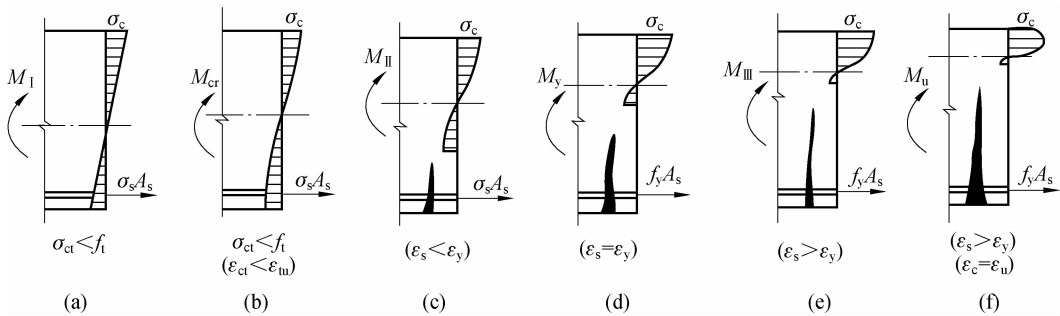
钢筋混凝土梁正截面的三个工作阶段
